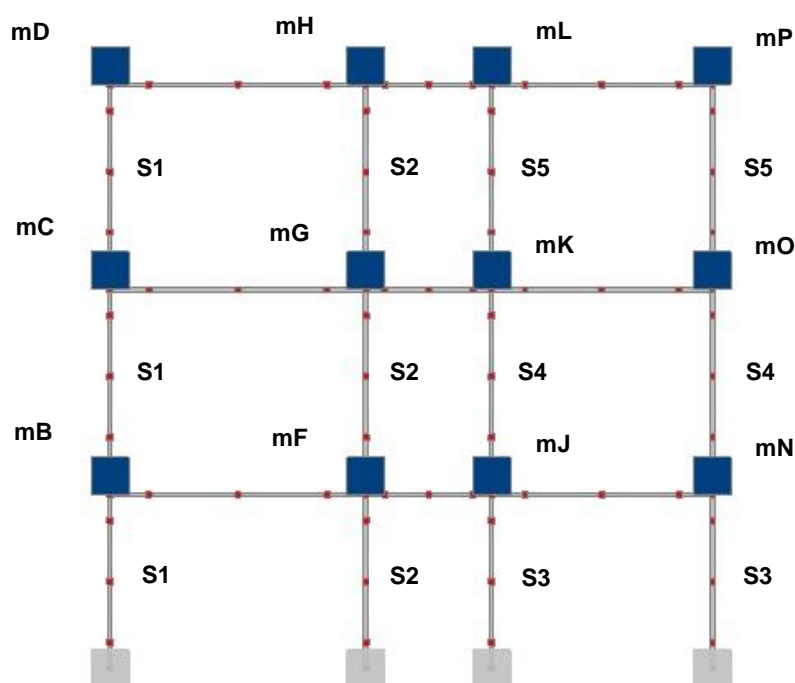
Pórtico Mod4 com indicação das secções e das massas aplicadas nos nós.
